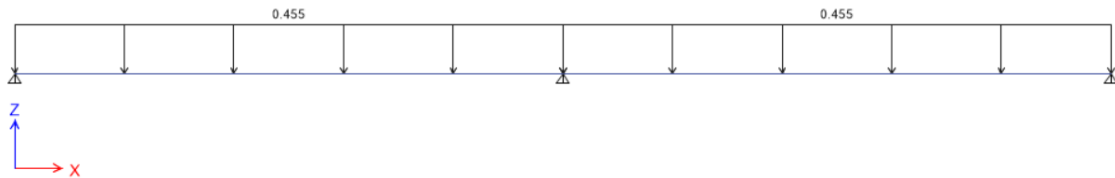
Carga última aplicada en la viga del piso típico.
